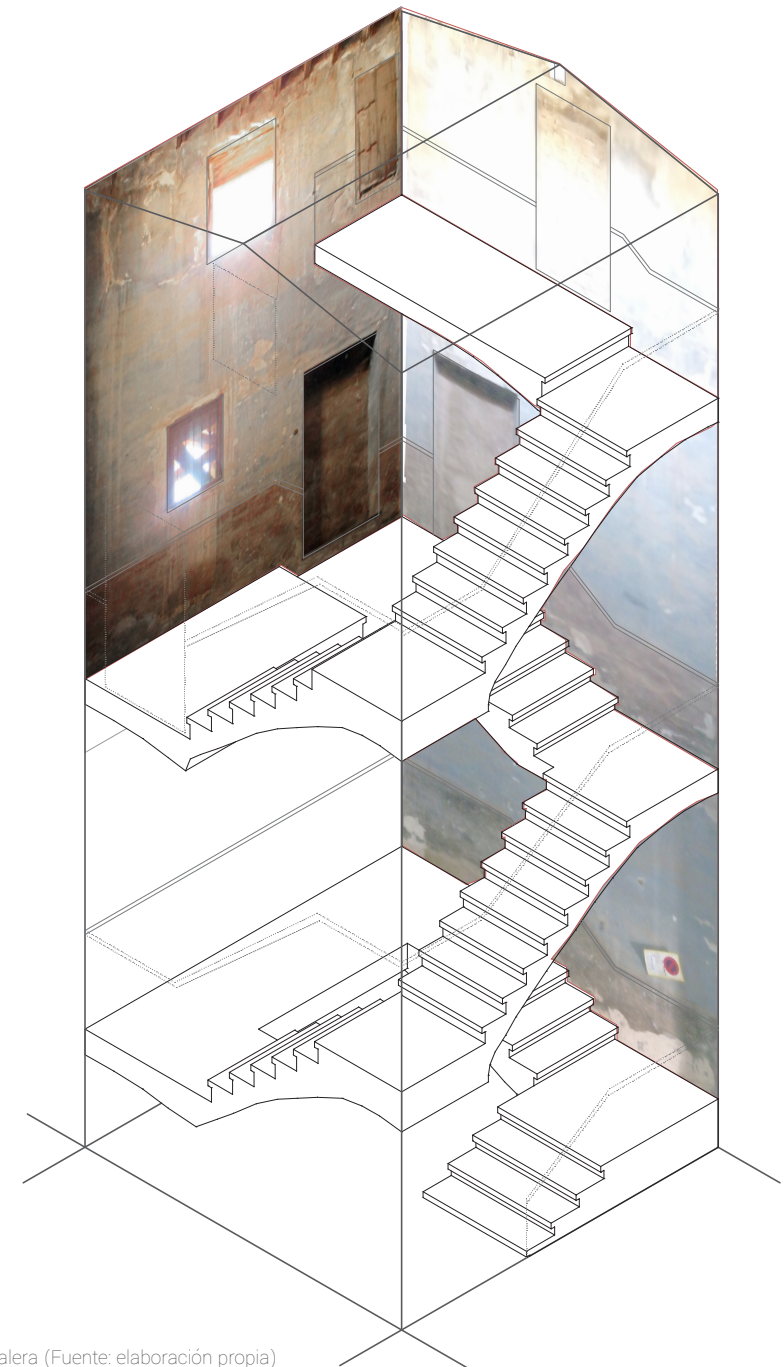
Reconstrucción del trazado de la escalera (Fuente: elaboración propia)
